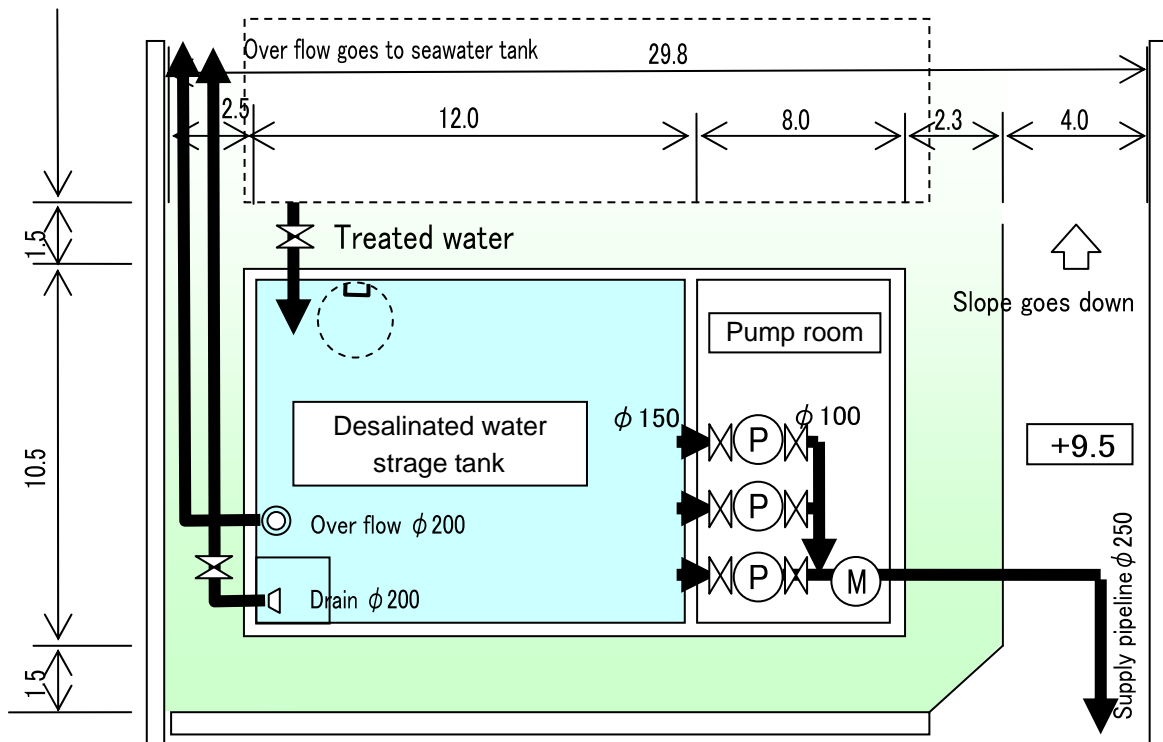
浄水貯留槽及び配水ポンプの概略配置図
